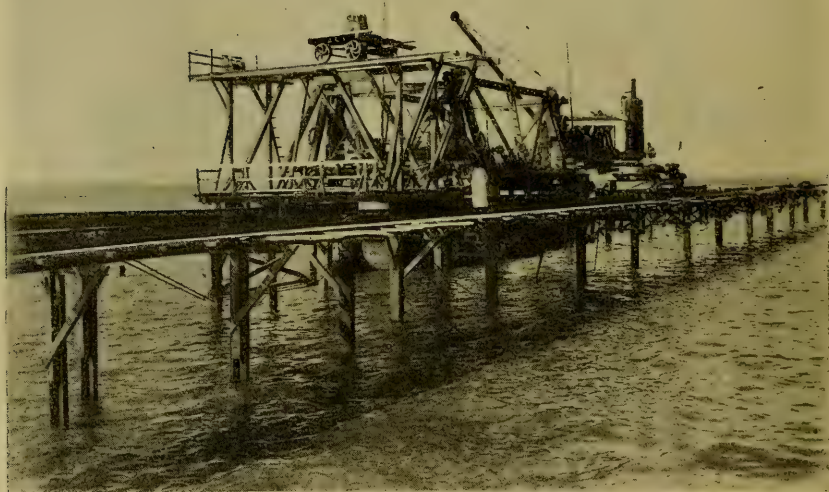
Sección subfluvial. Puente de servicio sobre el canal dragado
